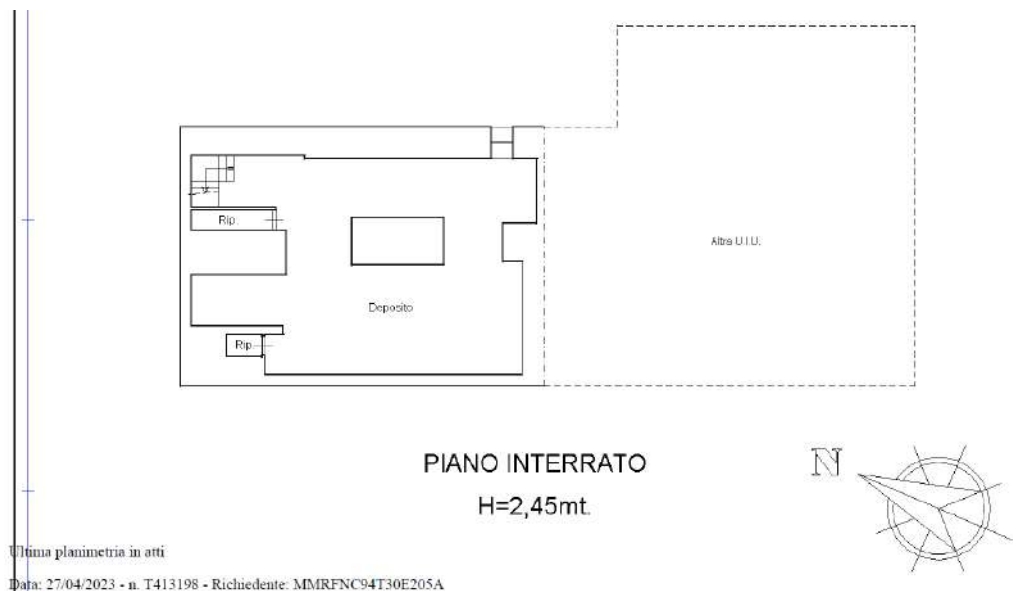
PLANIMETRIA IN ATTI CATASTALI PIANO INTERRATO – CONFORME
